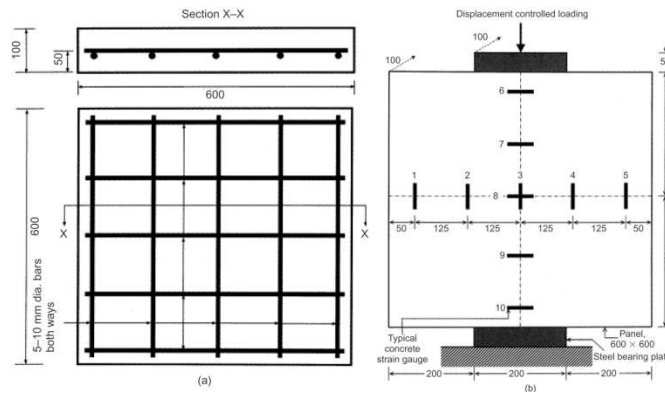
(a) Detalle de armado de los paneles ensayados (b) Disposición de las galgas para el ensayo. [13]
